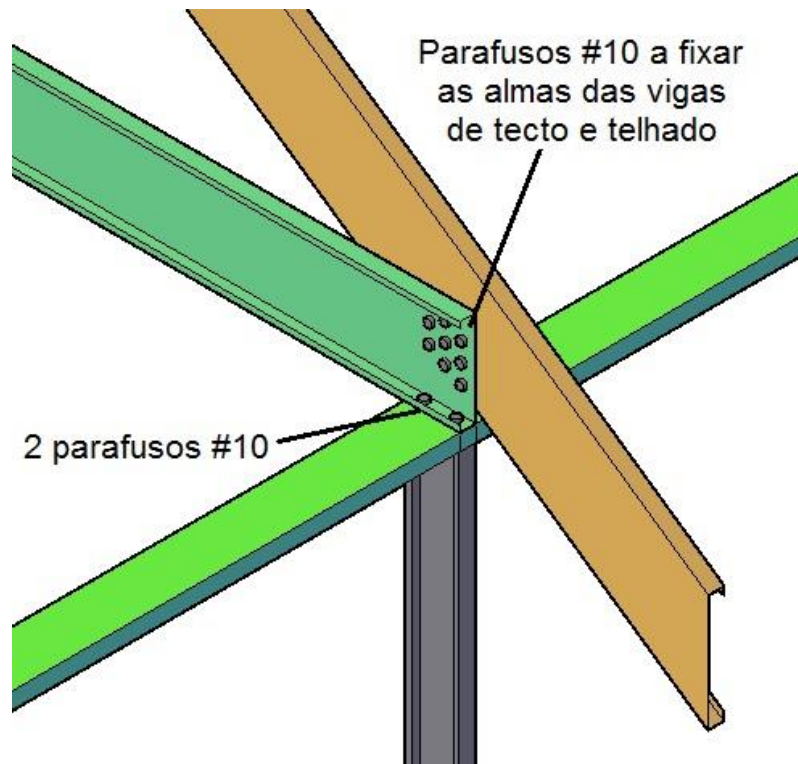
Pormenor da ligação entre vigas no beirado
